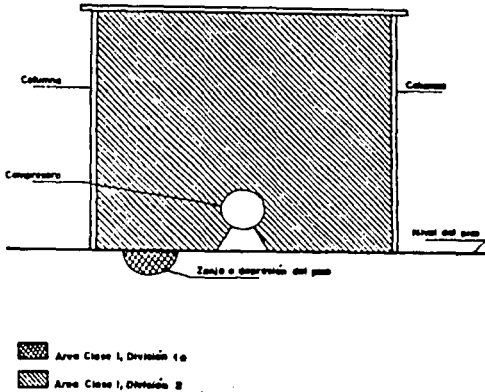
Áreas peligrosas en compresoras instaladas en estructuras techadas sin paredes, libremente ventiladas.
